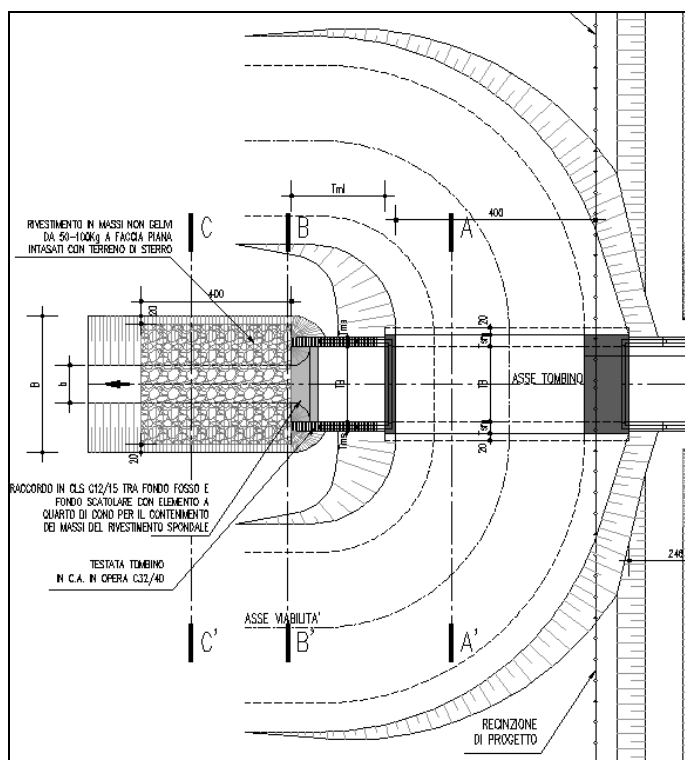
PLANIMETRIA IMBOCCO/SBOCCO CONSORZIO DI BONIFICA EMILIA CENTRALE
